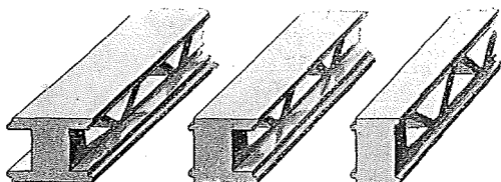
Alm. Bjælker, med Flanger til begge Sider, med Flange til den ene Side og uden Flange
